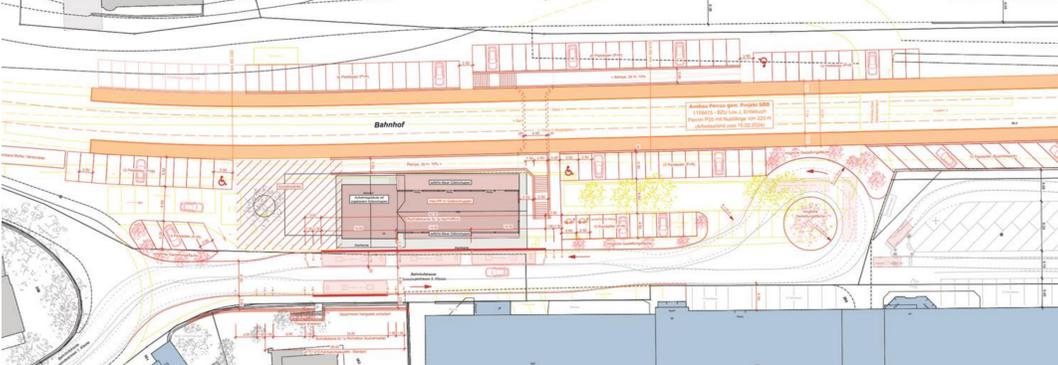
Ausschnitt aus Plan 031 – Variante C
